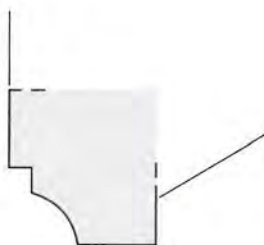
Nordwestflügel, Nordostfassade, Fenster von 1632, Profil des Gewändes vom 1. Obergeschoss, Aufnahmeplan 1980. M 1:10.
